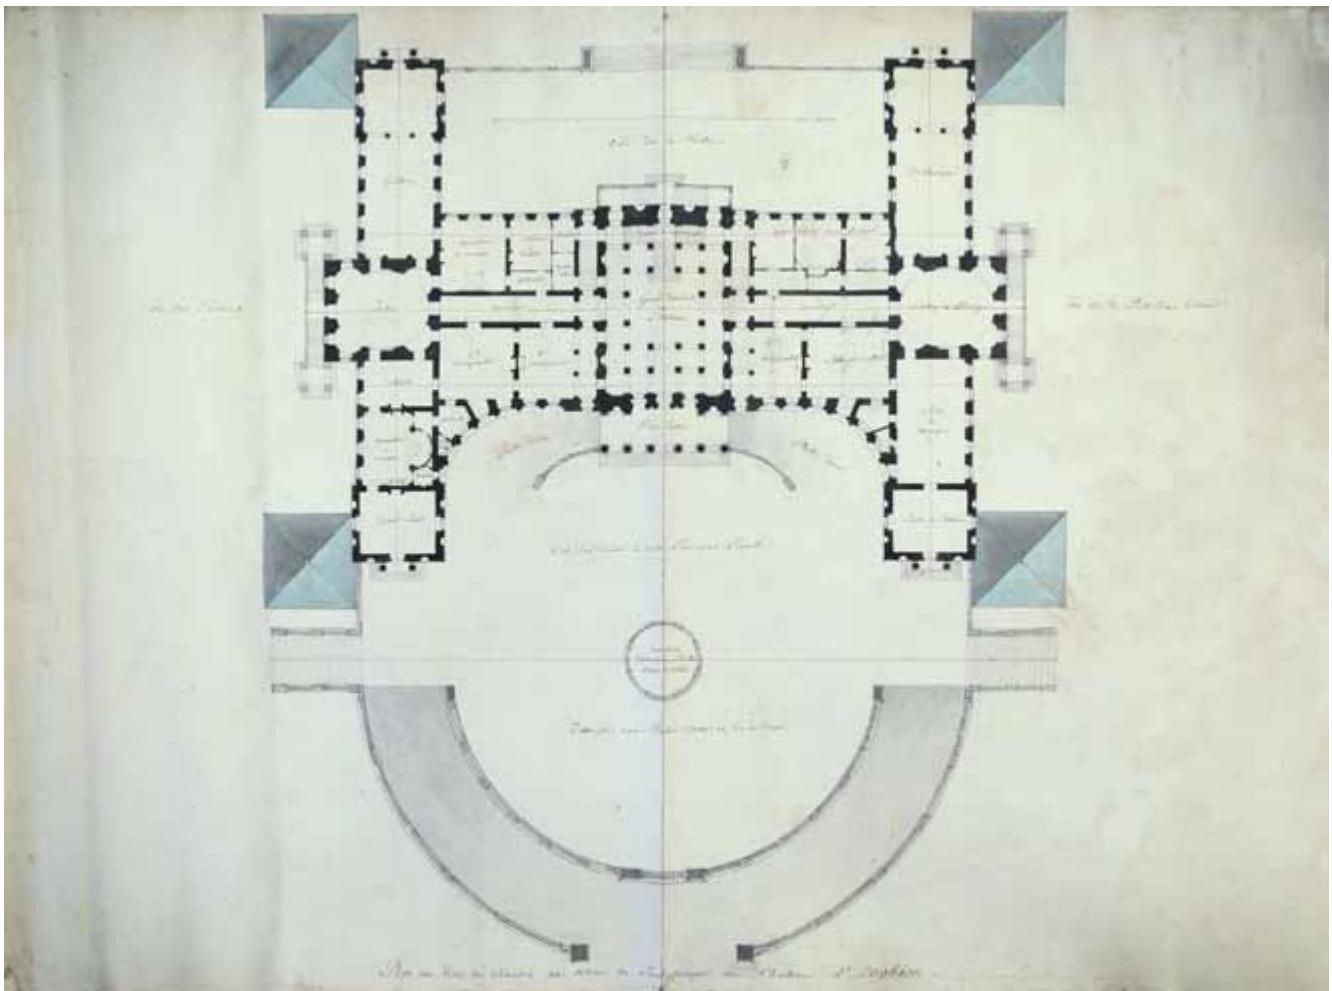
Projet de plan général, rez-de-chaussée (Archives Générales du Royaume).
